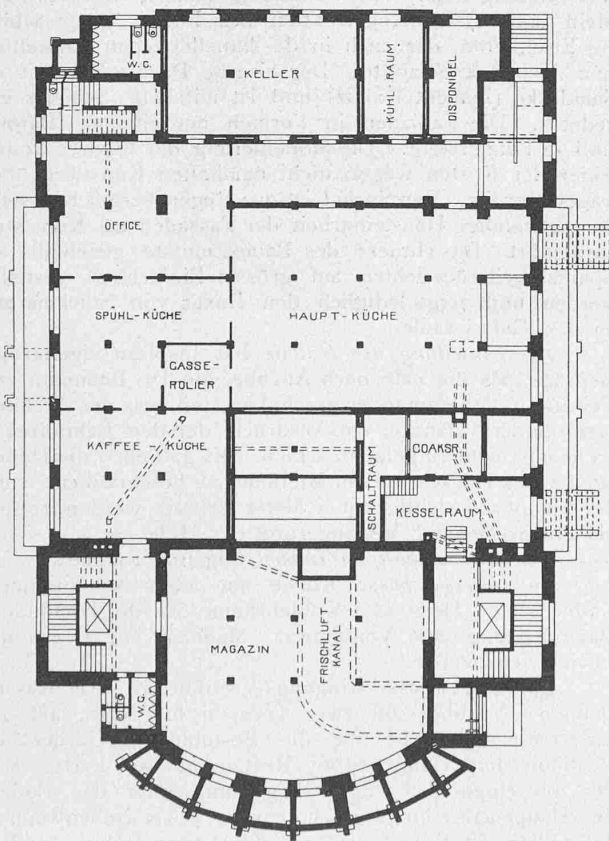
Grundriss vom Kellergeschoss.
